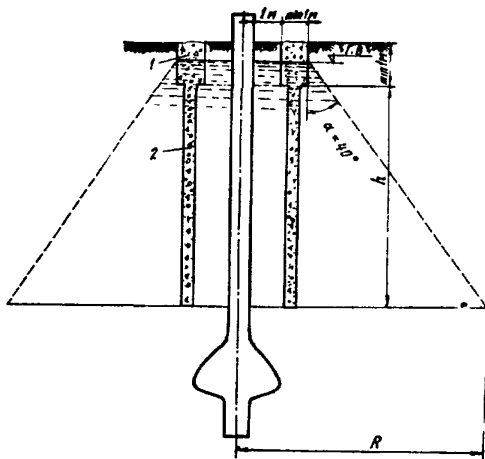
Схема замачивания просадочных грунтов вокруг испытываемой сваи:
